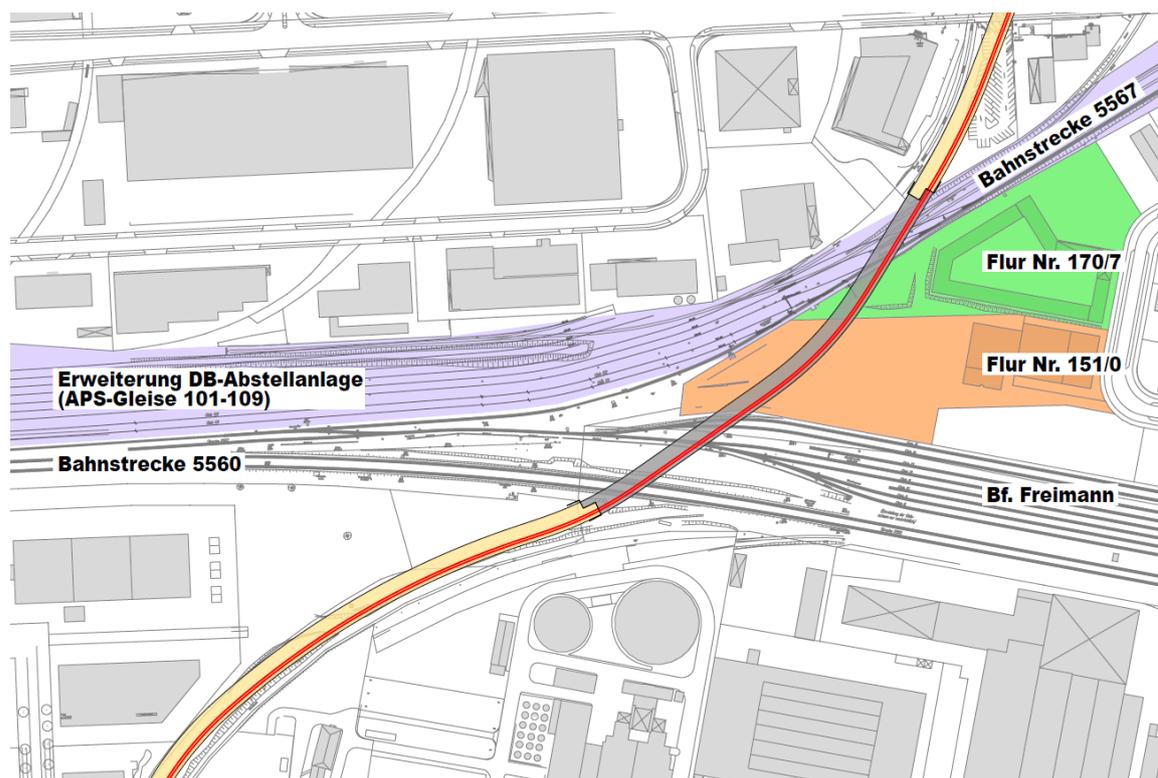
Lageplan, Variante 5 - Ostlage optimiert
